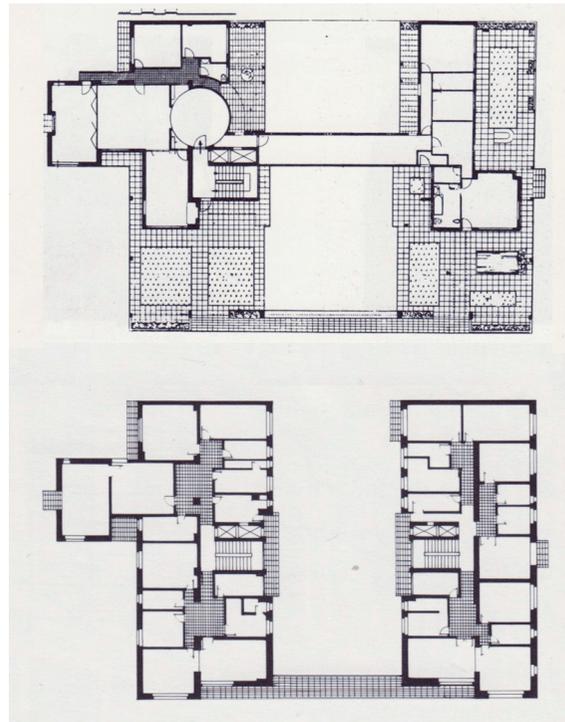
Haus Rustici, Grundrisse: 3. Obergeschoss, Dachgeschoss
